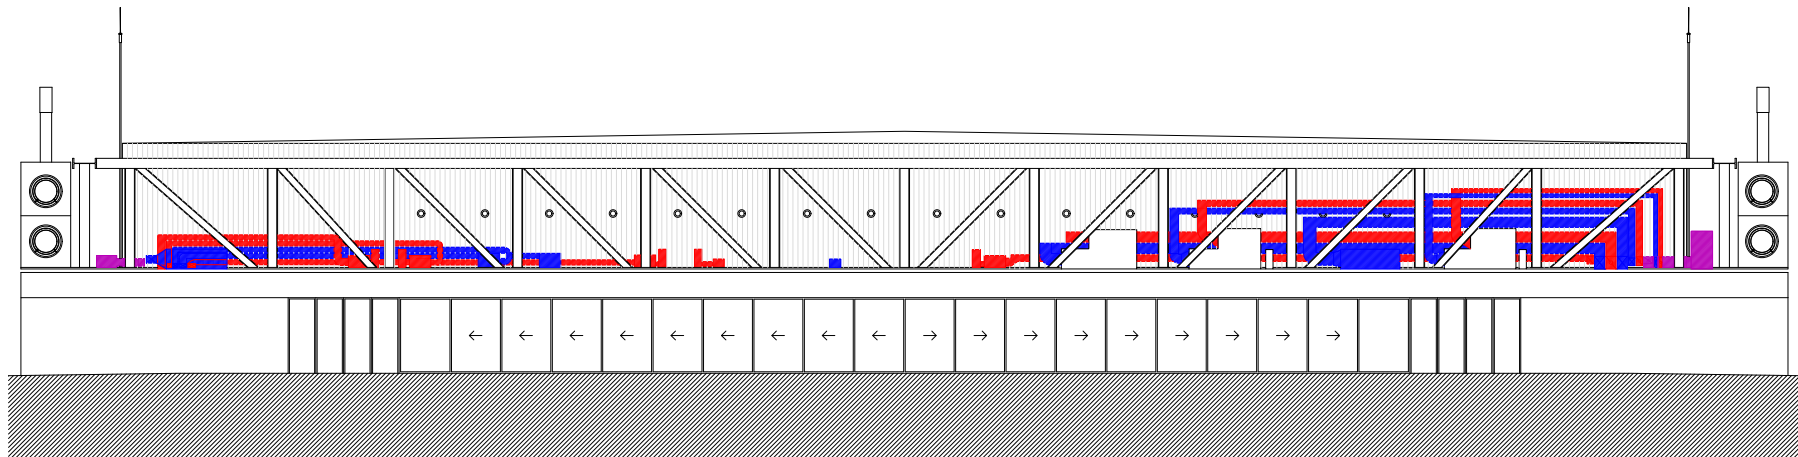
Planta de localización en fachada dos elementos técnicos de HVAC da planta baixo chan.
